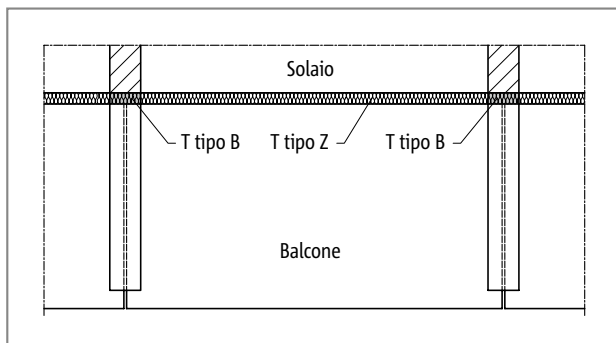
Schöck Isokorb® T tipo B: balcone con travi a sbalzo (balcone prefabbricato)
